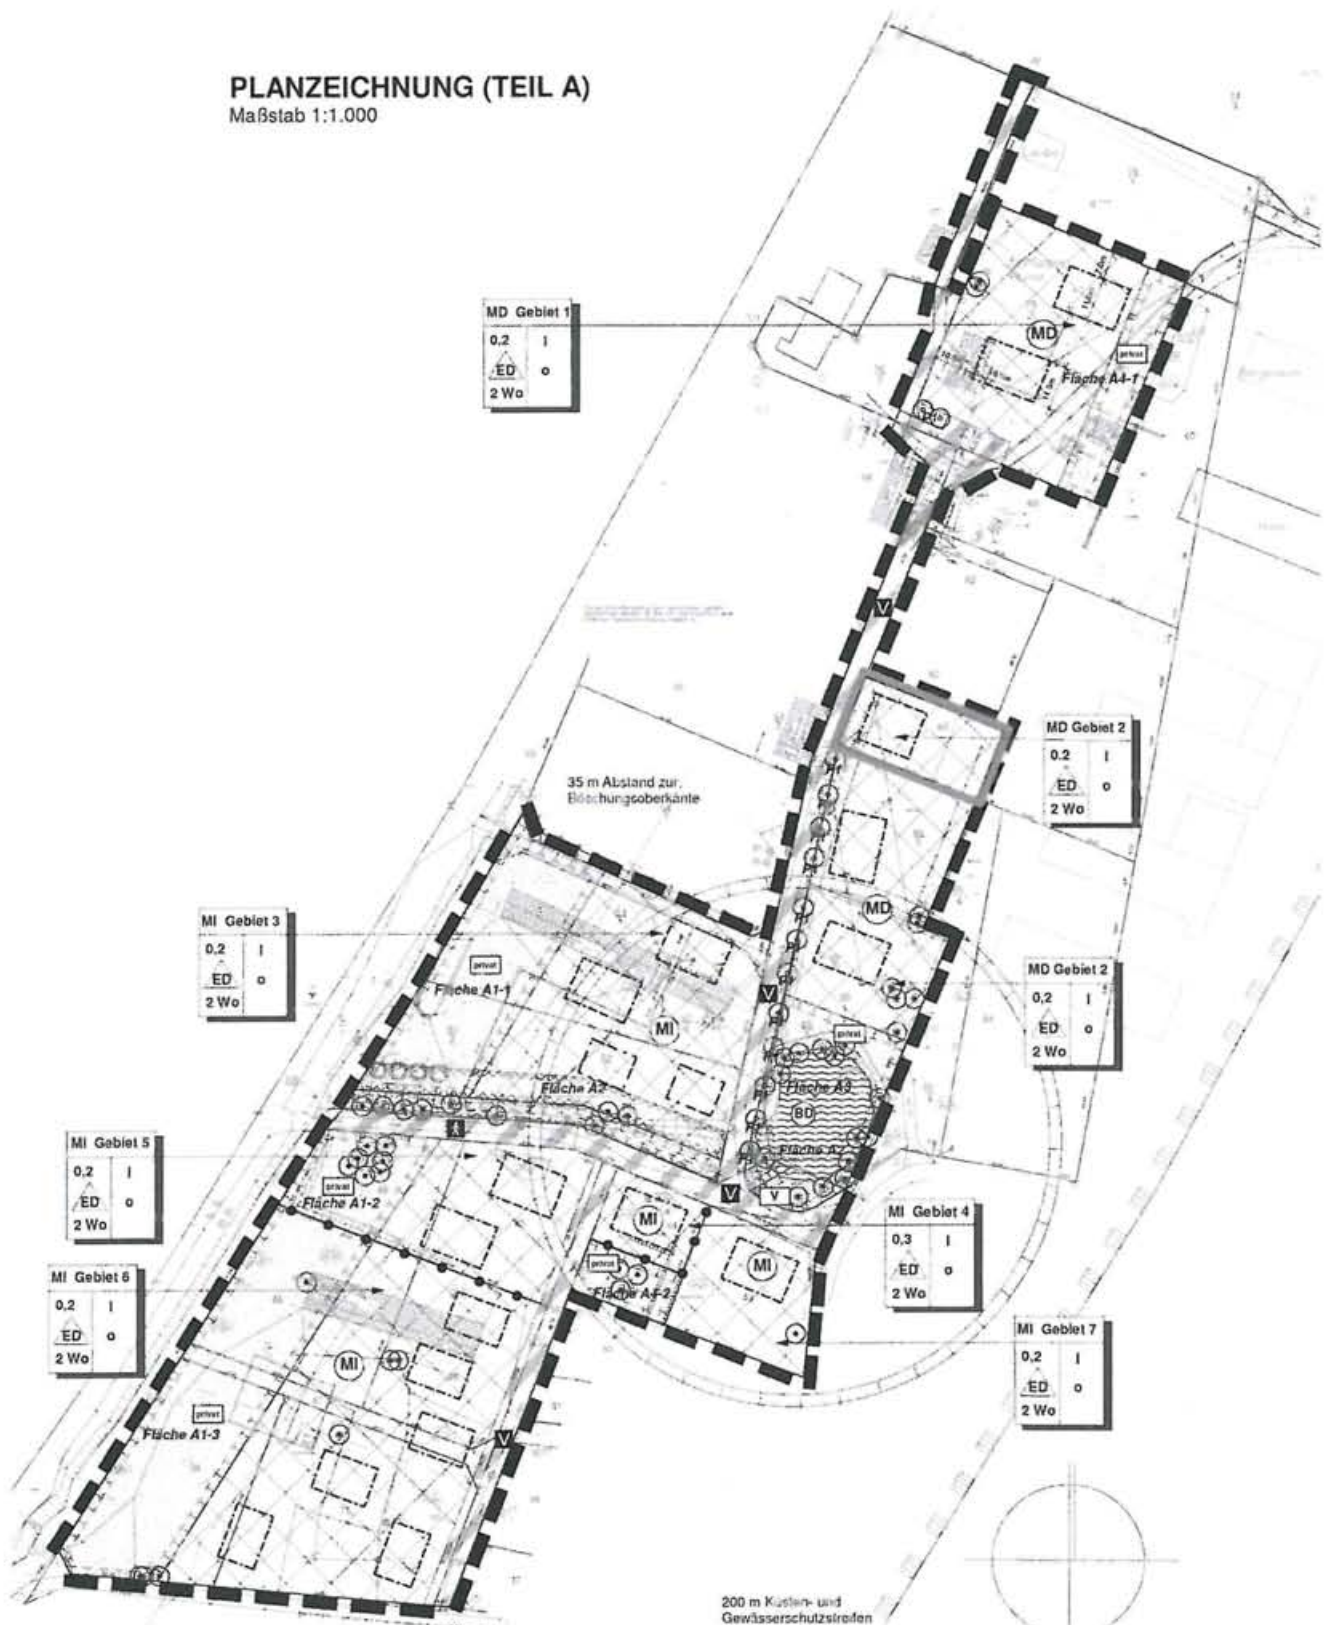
Planzeichnung (Teil A) Stand 1. Änderung und Ergänzung, ohne Maßstab
